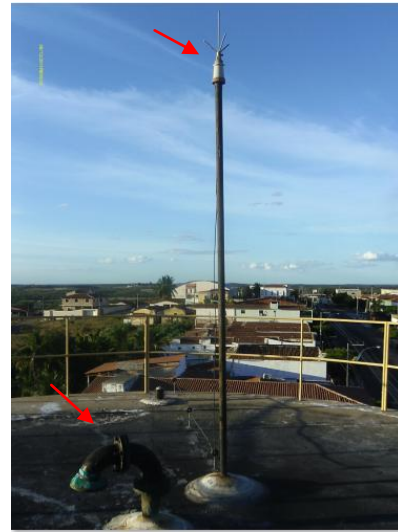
REL-01: tubulação de ventilação com tela de proteção e para-raio.
